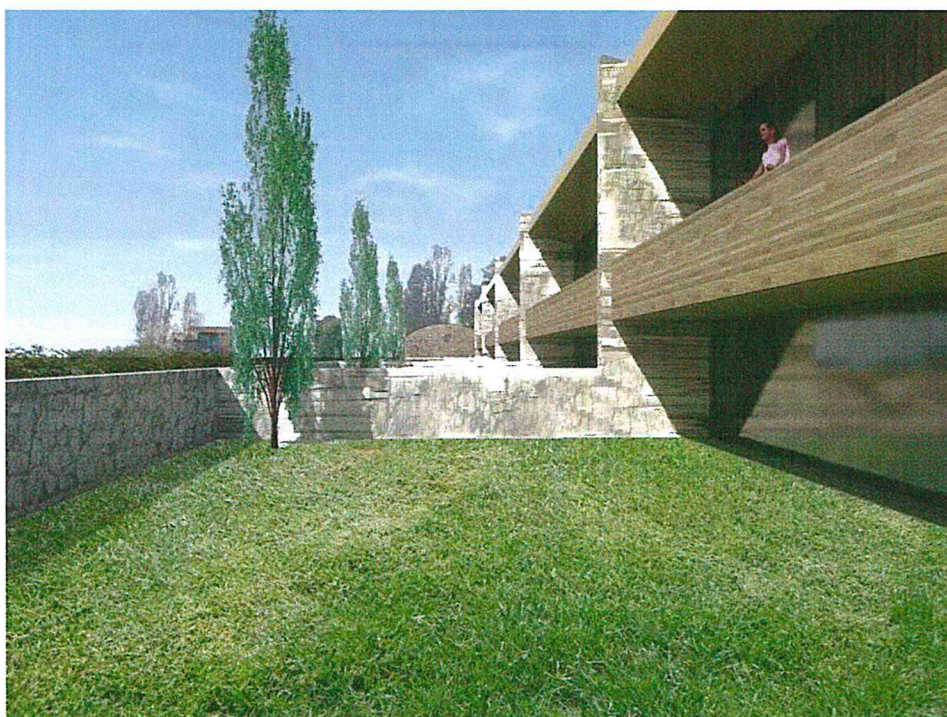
Simulazione dell'ipotesi di progetto. Vista dall'interno del giardino della villa a schiera. Sulla sinistra è possibile notare l'esistenza del muro in sasso sbazzato previsto in mantenimento per l'altezza interna di un metro.
